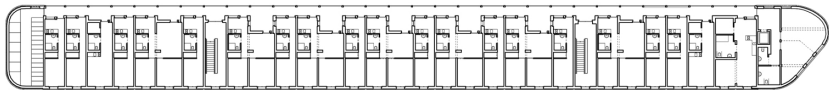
Wohnen am Dantebad 1, Grundriss 3. Obergeschoss. Florian Nagler Architekten, 2016.
